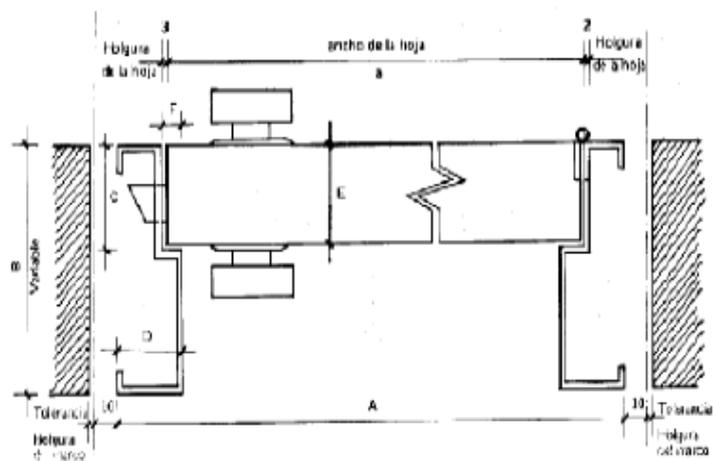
Puerta con marco metálico (dimensiones en mm)
